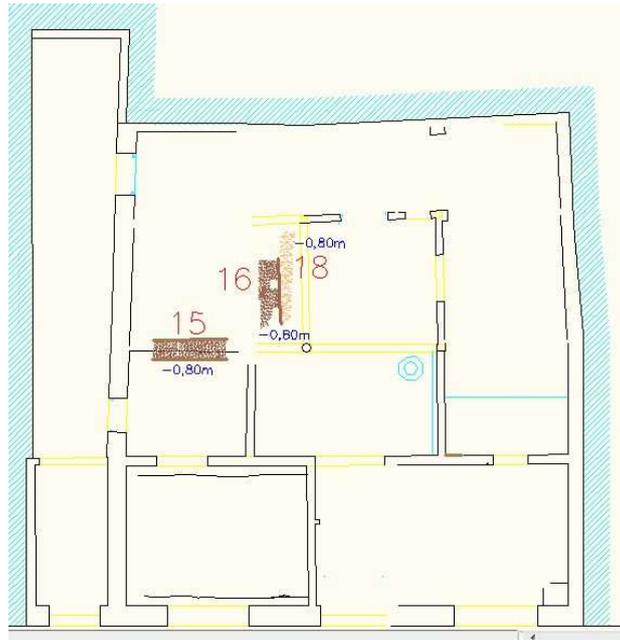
Ubicación en planta actual de muros de tapial y pavimento asociado
